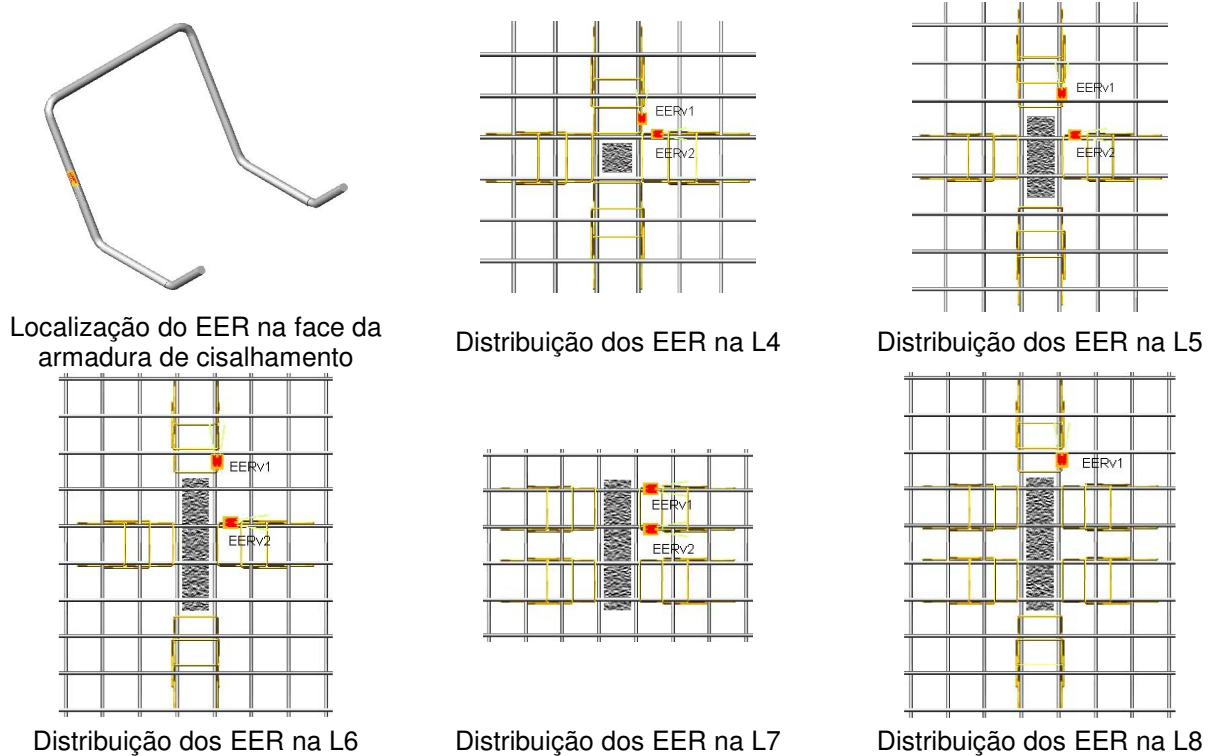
Disposição dos EER nas armaduras de cisalhamento
